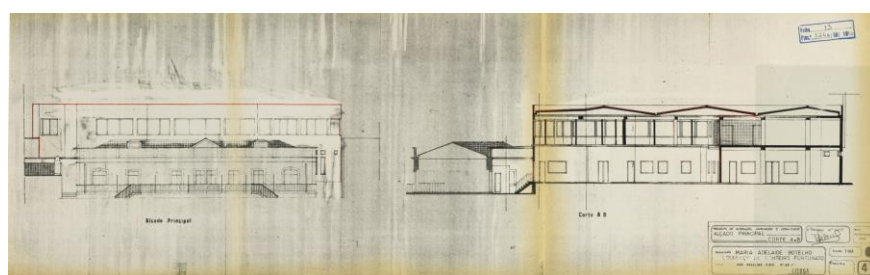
Fachada da construção ilegal sobre o edifício nº 23
